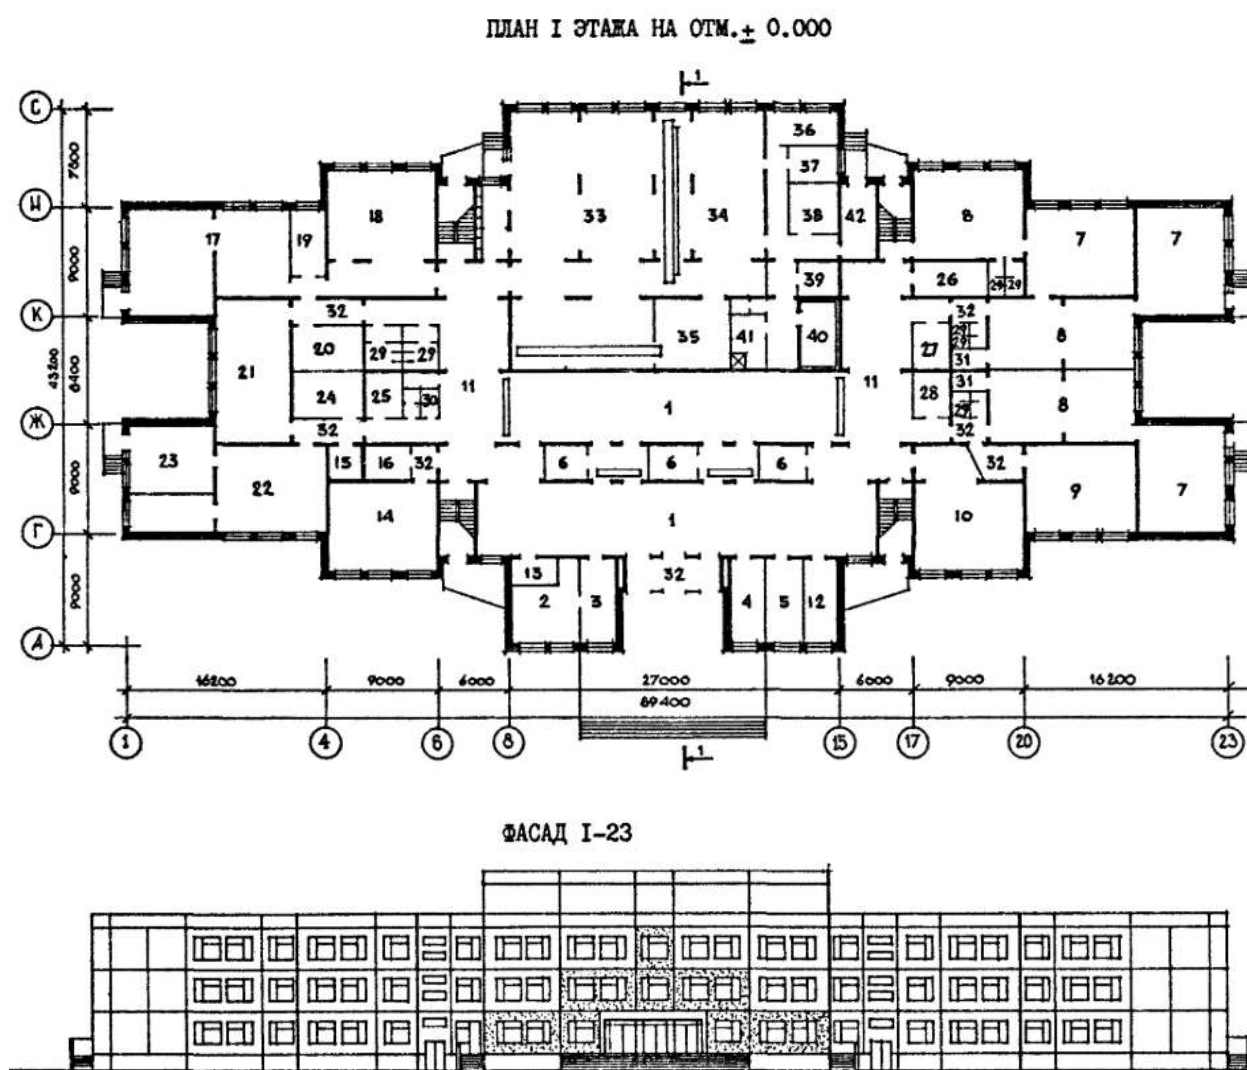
План 1-го поверху та фасад школи серії Т-8635
